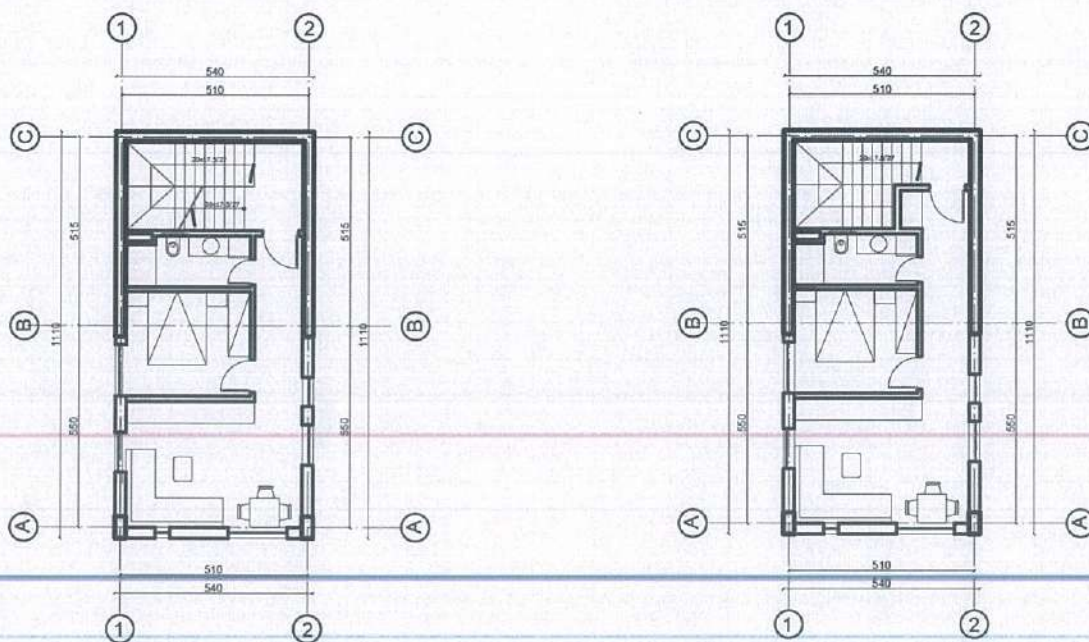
Planimetri e nivelit 3 dhe 4 te vilës
